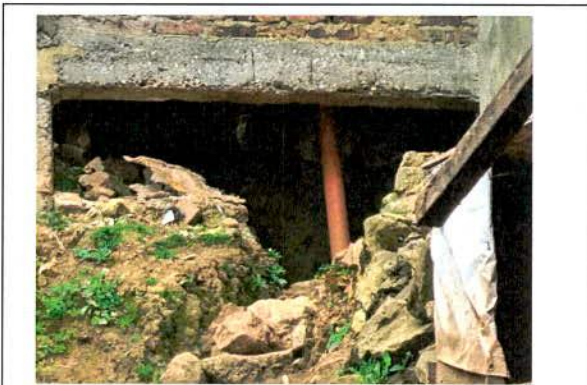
Vista de la vivienda de la Calle 6B No. 3 – 31.
